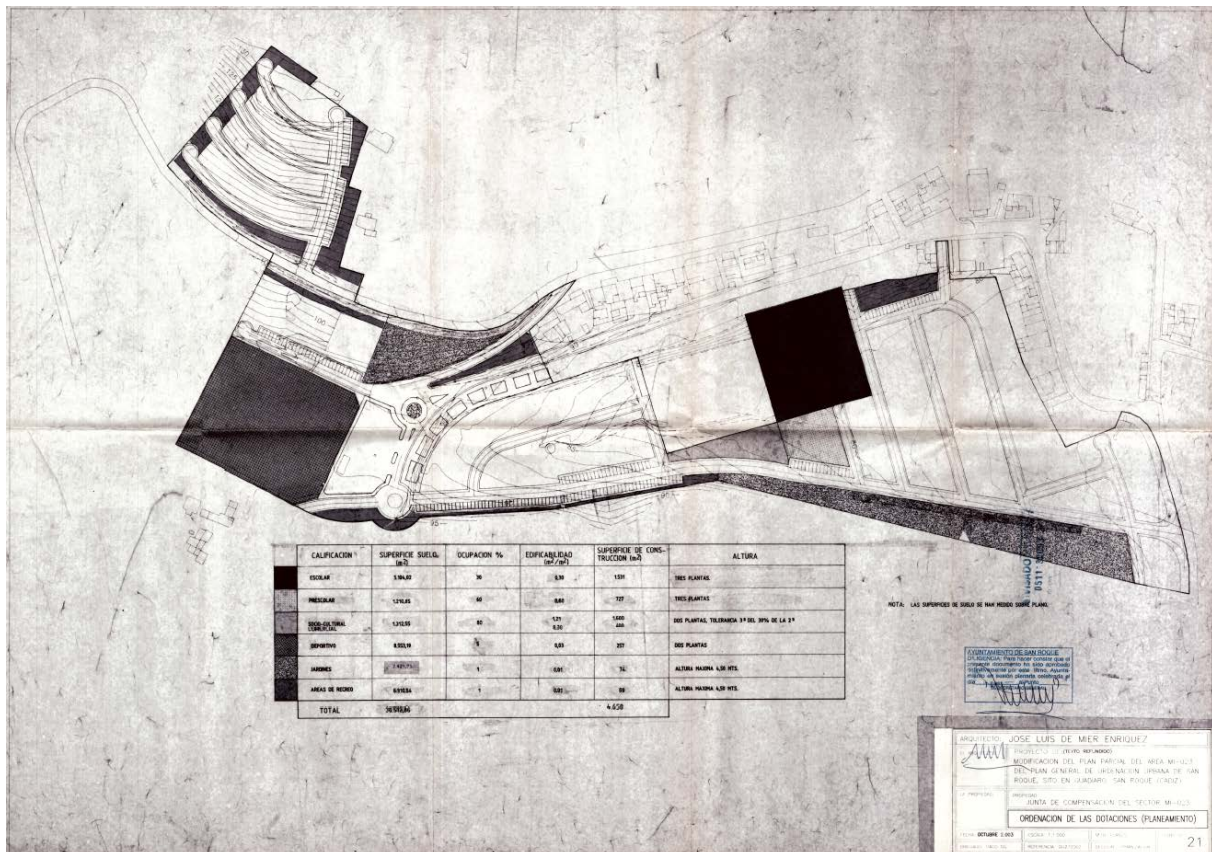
MODIFICACION DE PLAN PARCIAL DE AREA MI-23 .PLANO 21 ORDENACION DOTACIONES.16/03/2004
